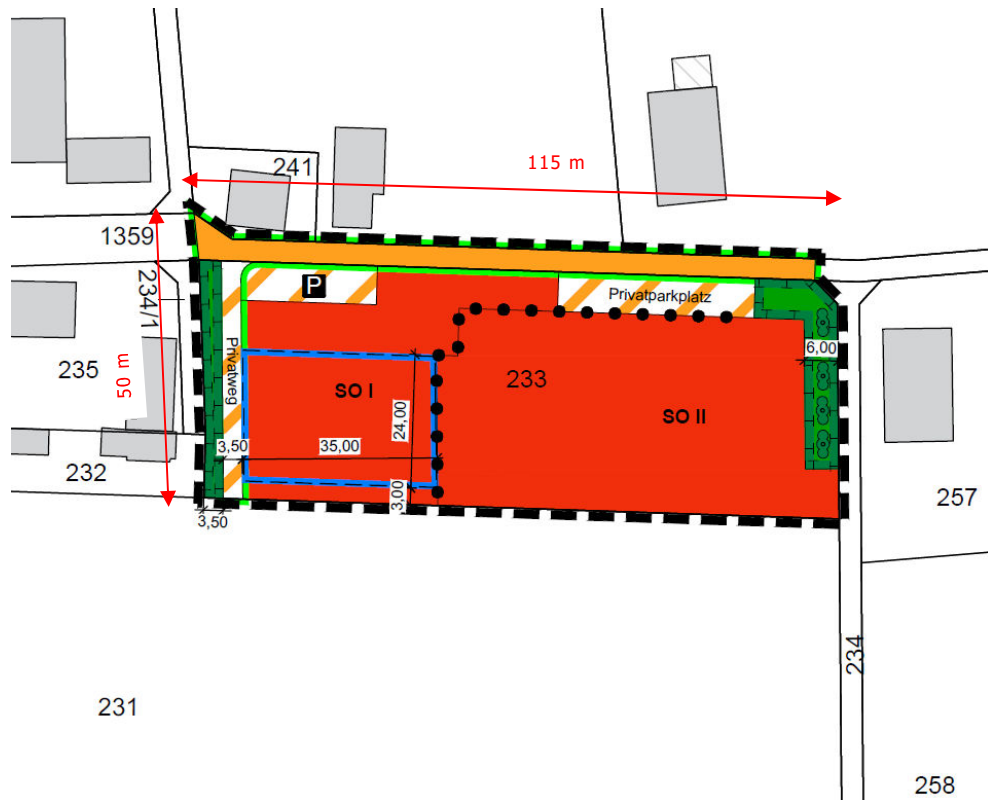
Übersichtslageplan Bebauungsplan „ALPACAMP“
